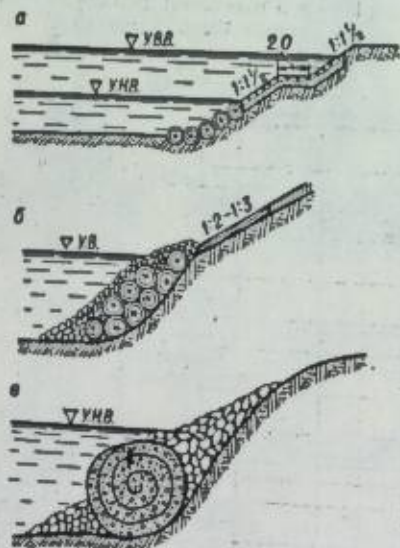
Крепления подводного берега: а, б — укладкой тяжелых фашин с каменной наброской; в — карбурами.
